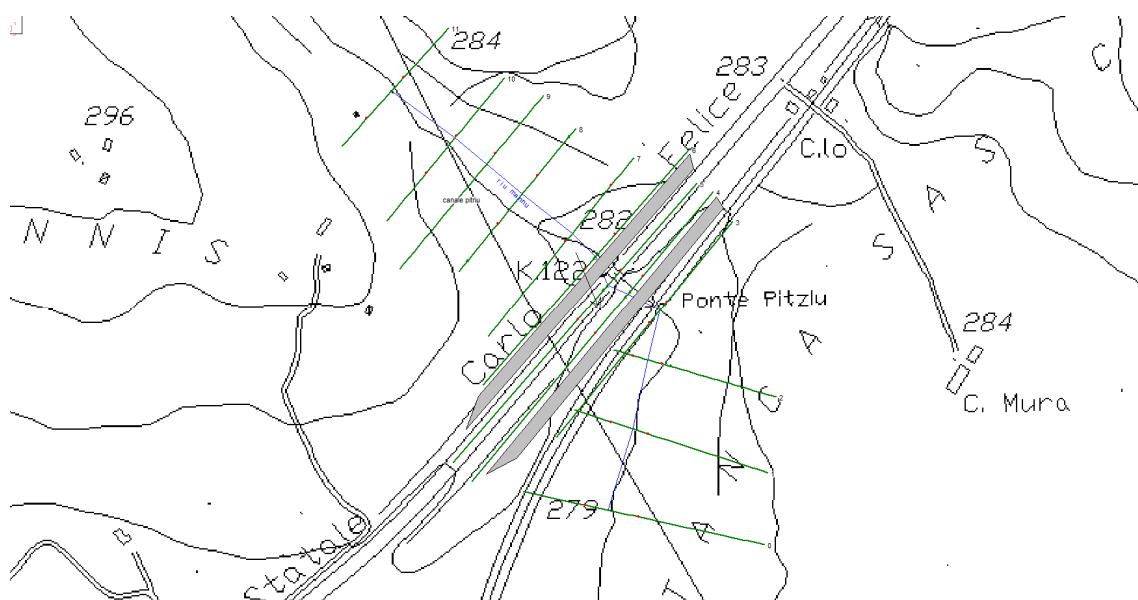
Interferenze a progr. km 122+025 (Riu Pitziu) – Schema planimetrico della modellazione
